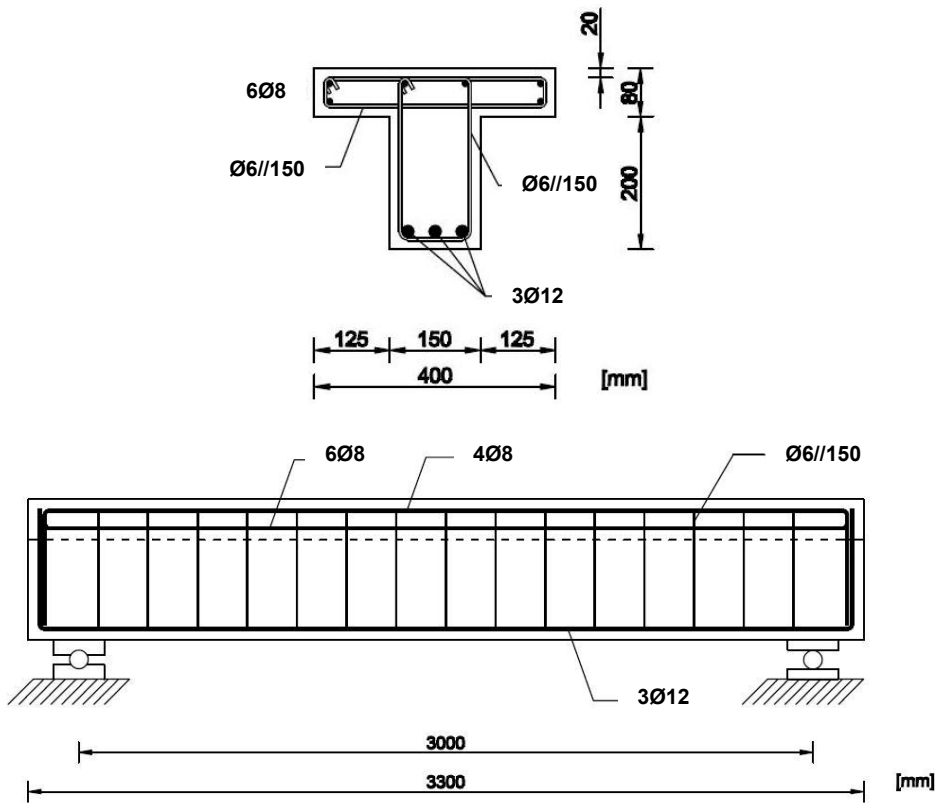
Pormenorização das armaduras constituintes das vigas
